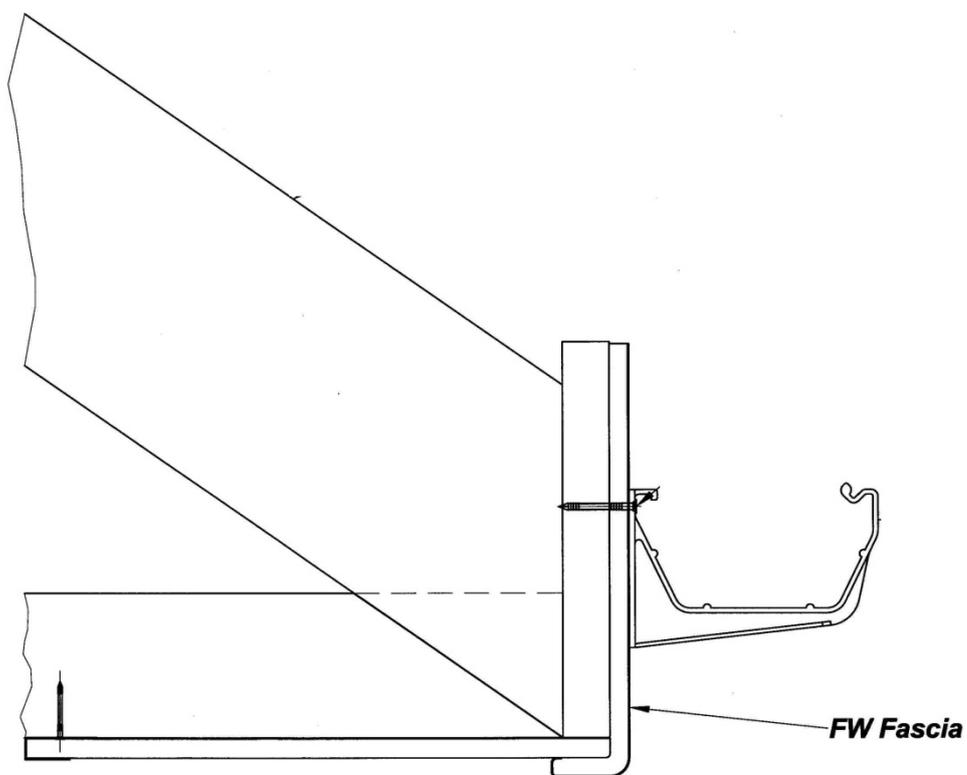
Principe de mise en œuvre de la gouttière sur planche de rive FW
